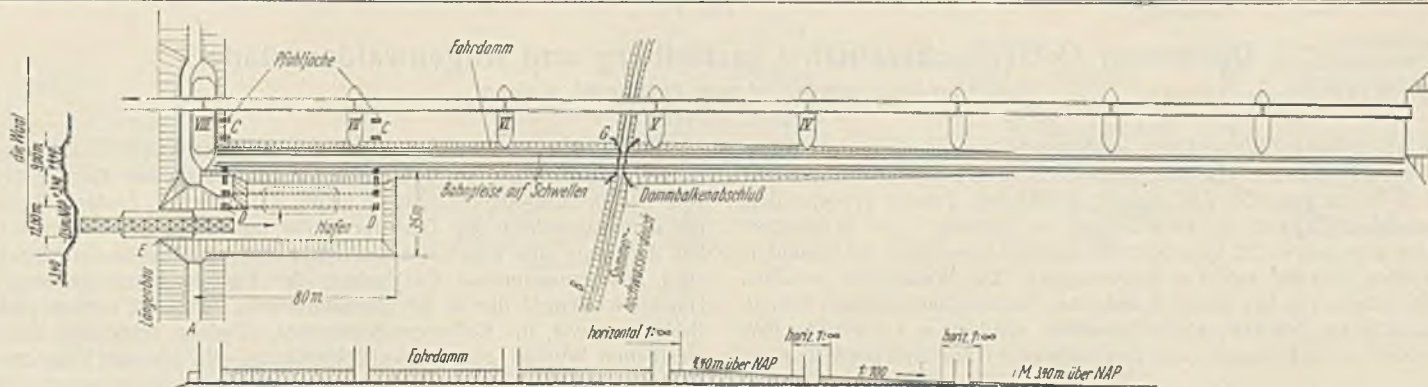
Lageplan des Bauplatzes mit Hafen und Fahrdamm-Querschnitt.
